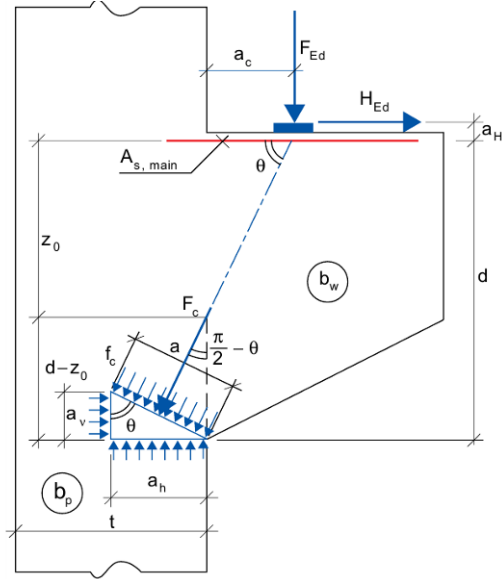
К определению угла наклона сжатого бетонного подкоса
